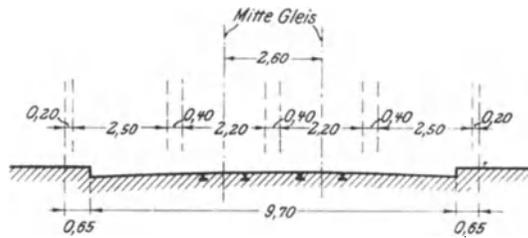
b. Vierspurige Straße mit zweigleisiger Straßenbahn.
